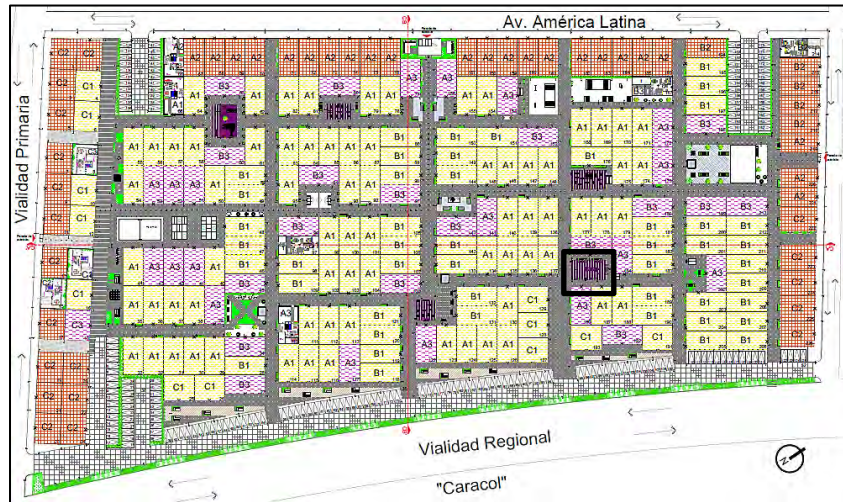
Plano de conjunto. Señalada dentro de un recuadro negro la ubicación de la plaza 9.
